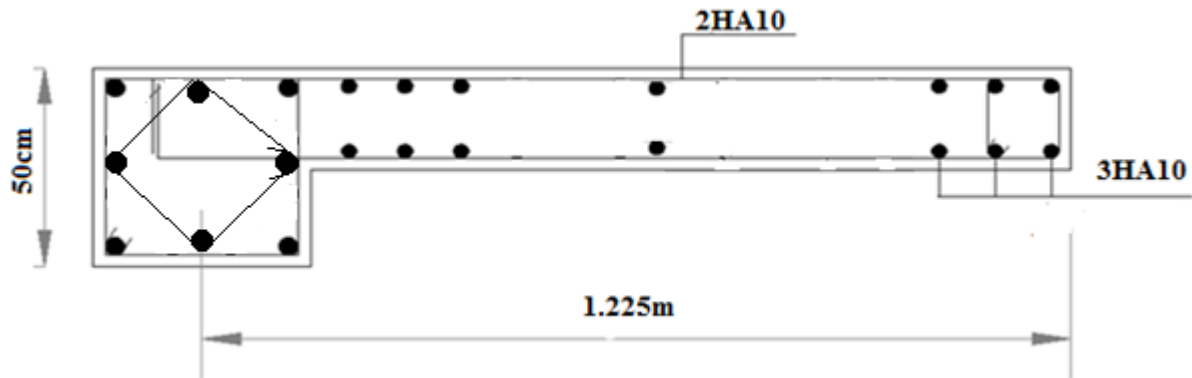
Schéma de ferrailage du voile V_{x1} (niveau RDC) :
